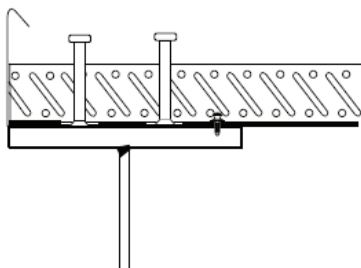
Cas d'une poutre de rive à double alignement de connecteurs
